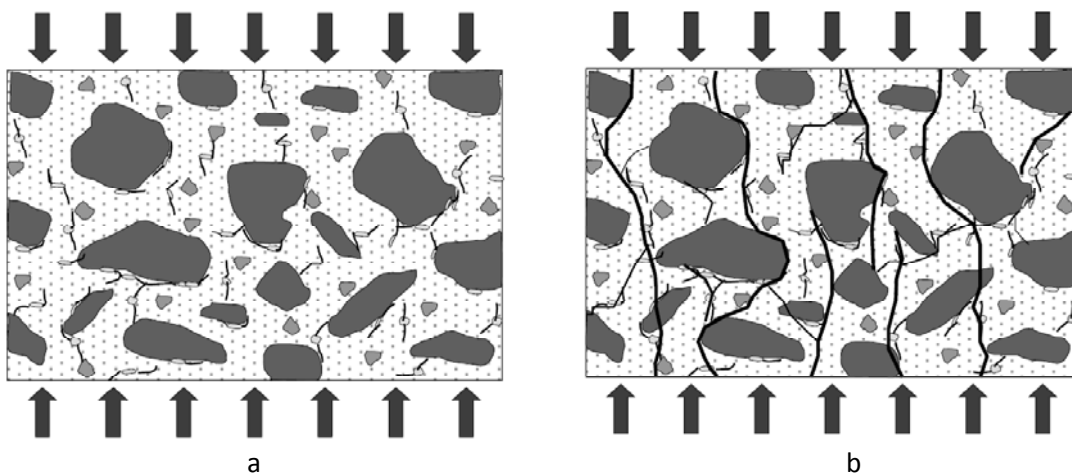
Ilustração de uma seção de concreto com falhas pré-formadas submetido a compressão: (a) progresso da microfissuração a partir de múltiplas falhas; (b) fraturamento do concreto submetido a força de compressão (HANAI, 2005)
